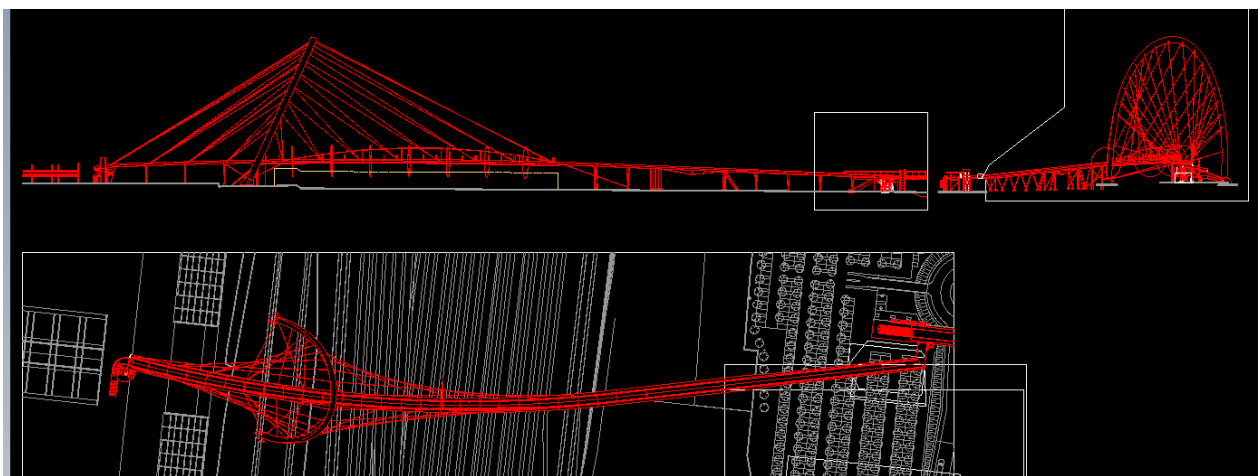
Draufsicht und Seitenansicht der 368m langen Olympia Brücke
